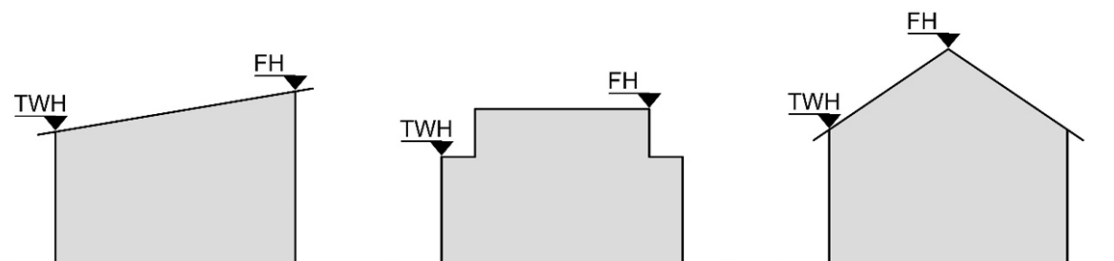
Definition der zulässigen Gebäudehöhen bei den entsprechenden Gebäudetypen
